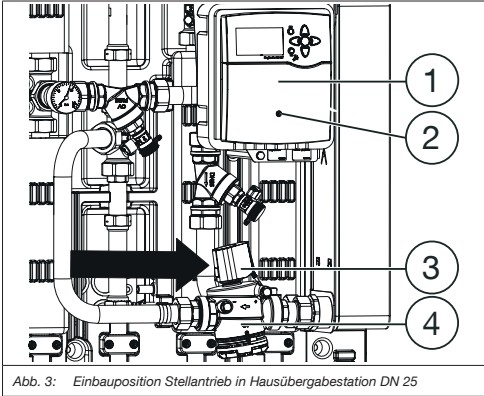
Einbauposition Stellantrieb in Hausübergabestation DN 25
